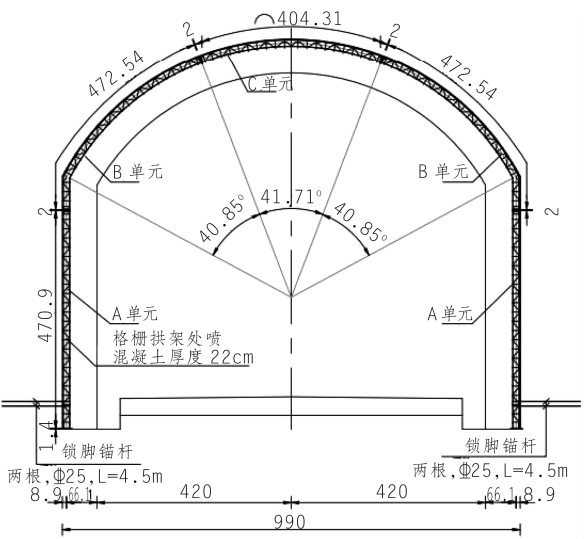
引水 2~4 号施工支洞 V 类围岩钢筋格栅拱架安装设计图(单位:cm)
